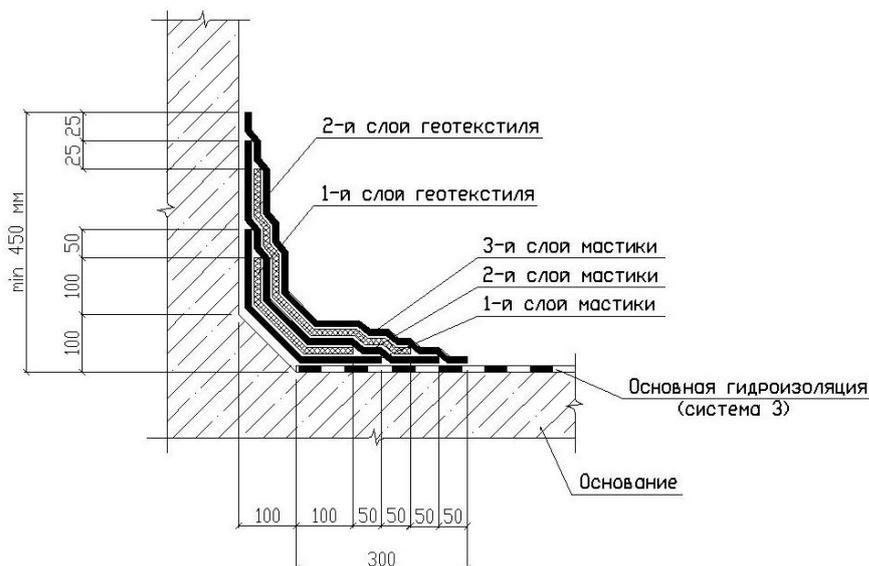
б. Устройство гидроизоляции примыкания после нанесения основного кровельного покрытия с двумя слоями геотекстиля.
